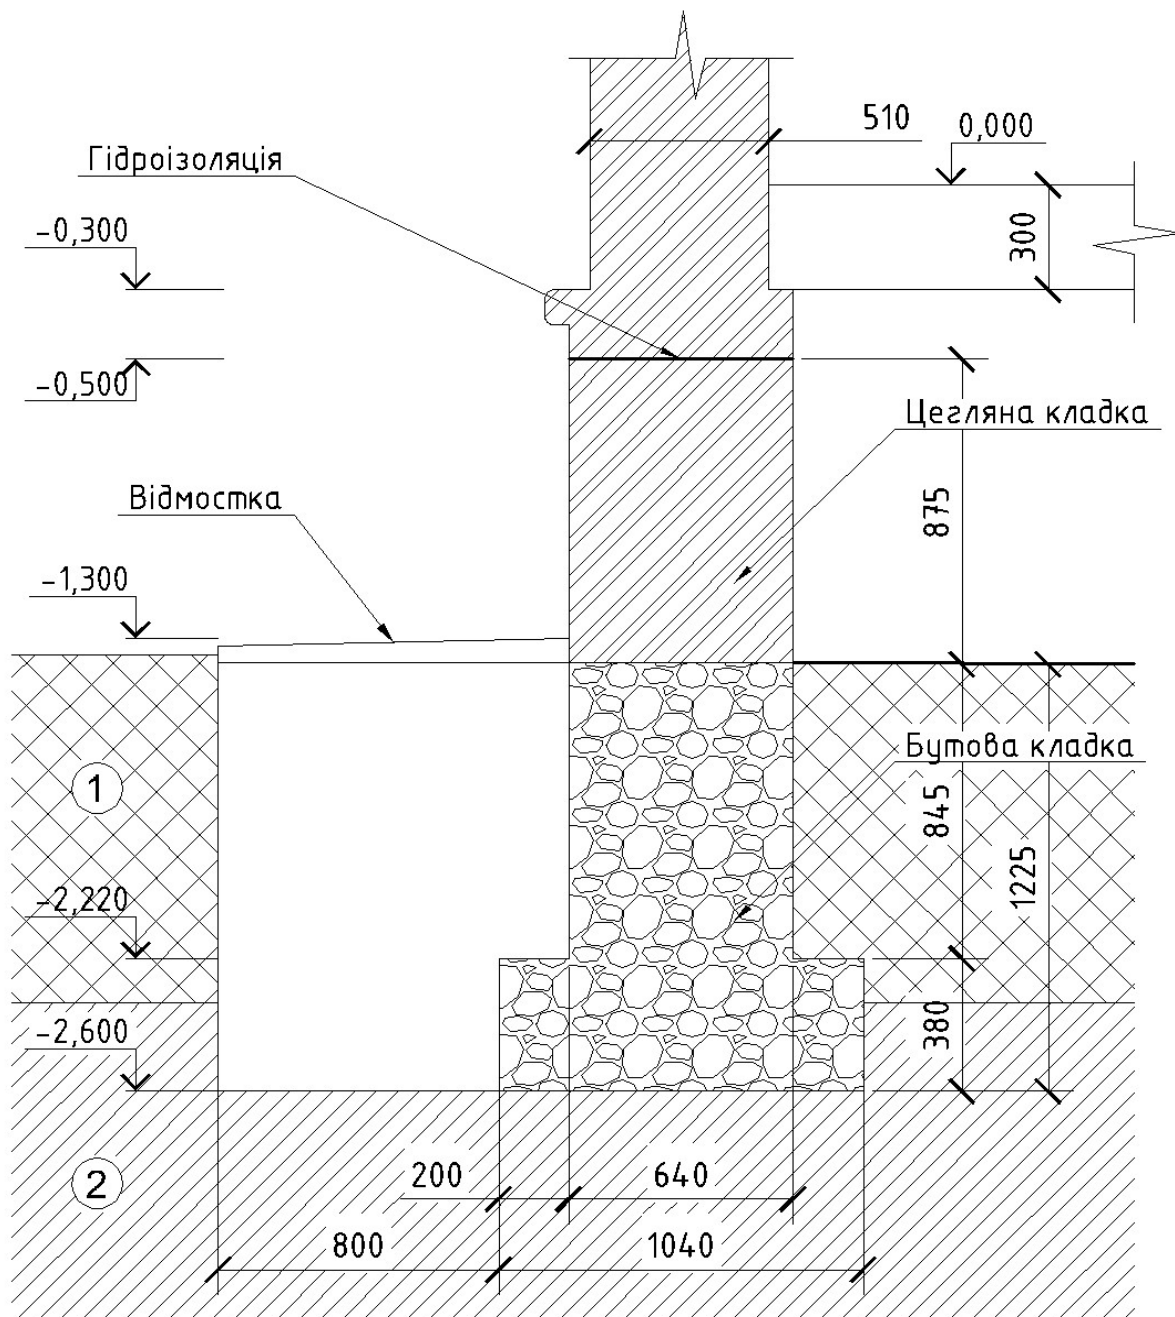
Переріз фундаментів зовнішніх стін
